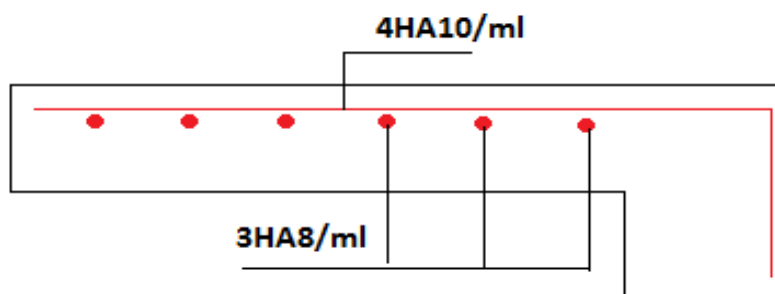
Schéma de ferrailage l'escalier RDC volée 2
